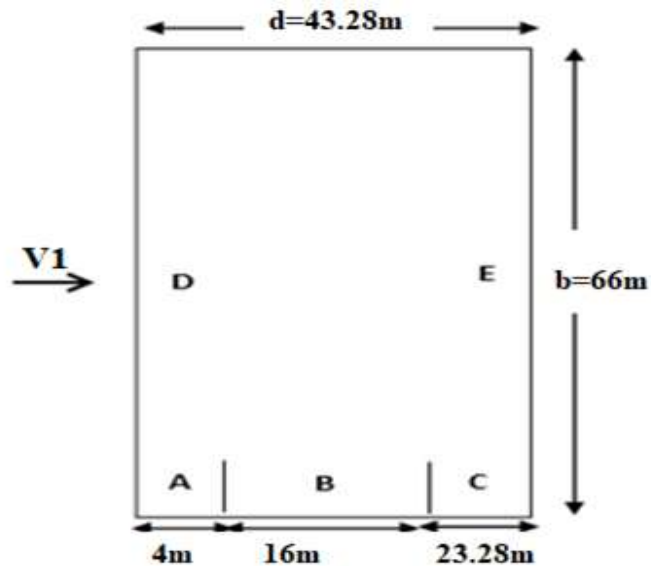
Vue en plan des zones de pression sur les parois verticales sens $V1$.
